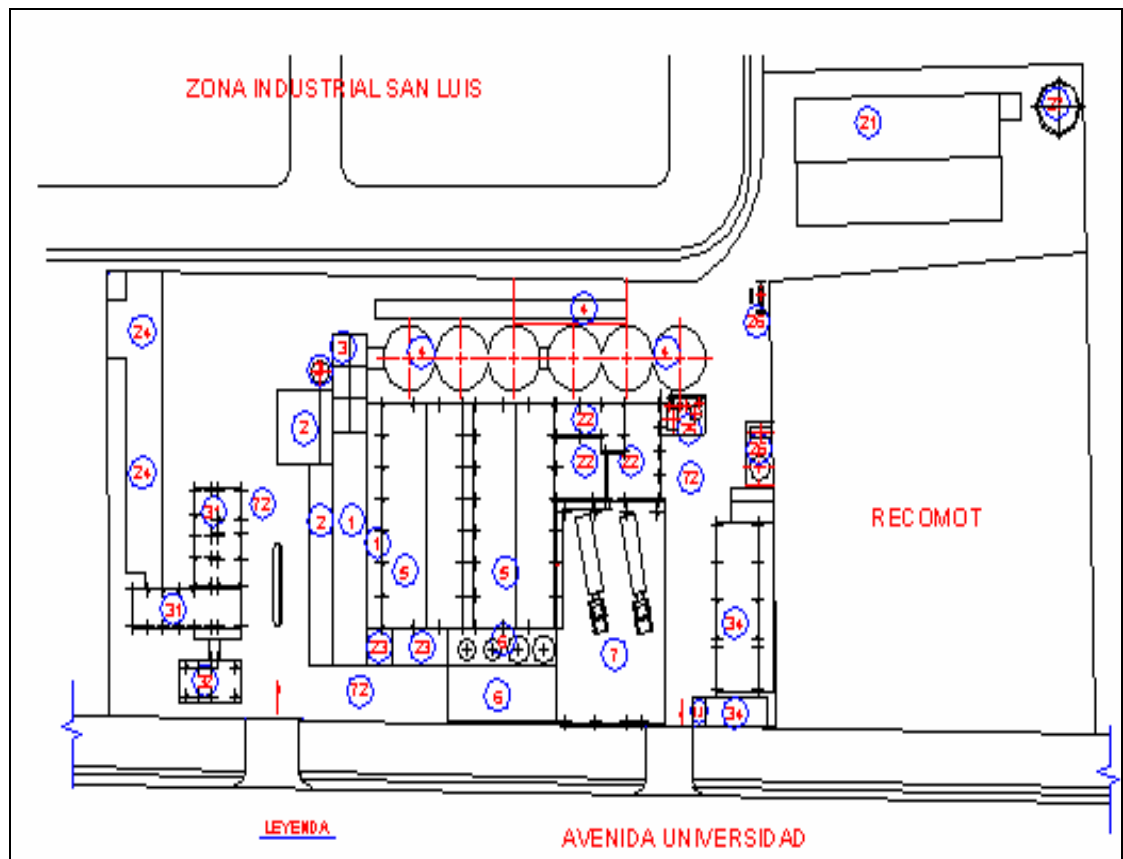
Ubicación Física de REMAVENCA Planta Cumaná
